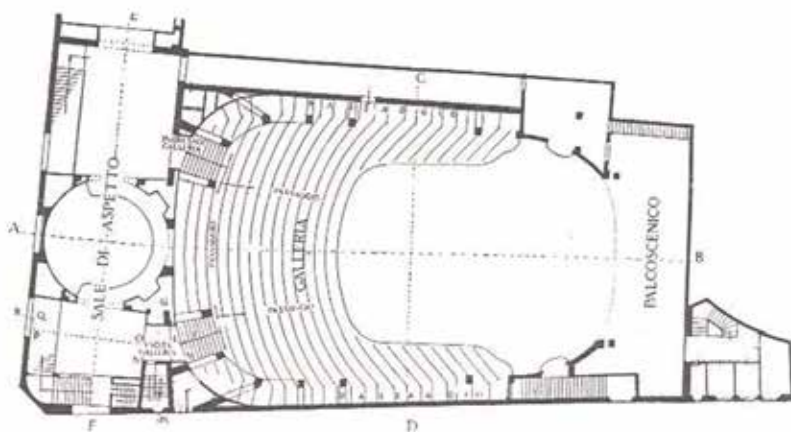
Esempio di pianta a ferro di cavallo, Cinema Barberini di Roma arch. M. Piacentini, pianta galleria
